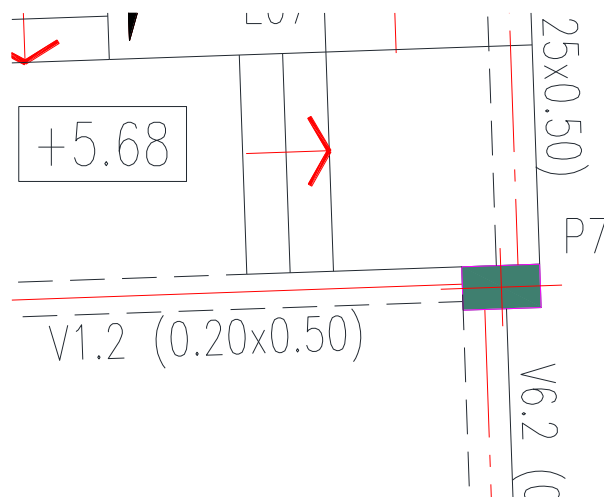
Parte da planta do piso à cota +5,68 m junto à zona da caixa de escadas (s/ escala)
